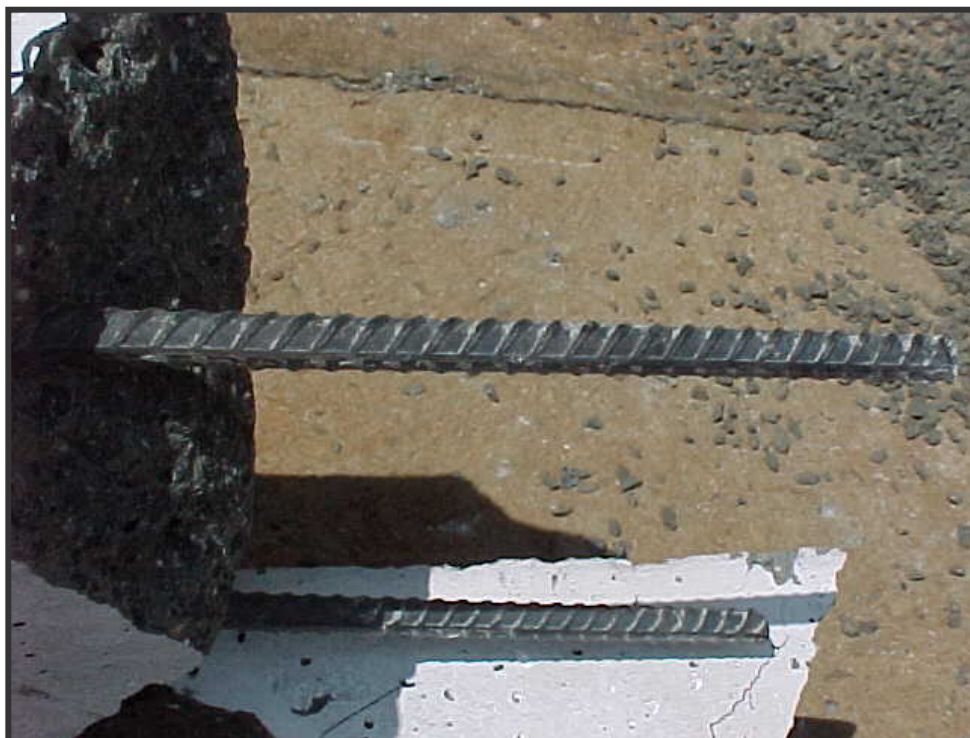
Detalhe da armadura da viga *CJ7* após ensaio.
